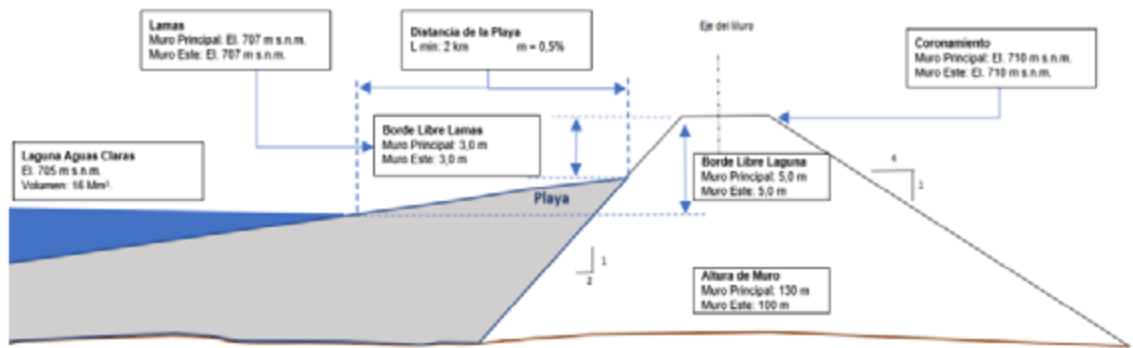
Sección tipo muro depósito de relaves Ovejería
